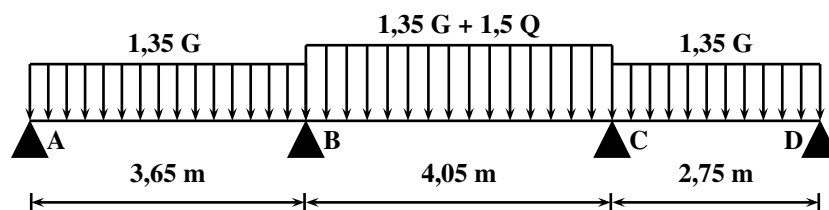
Poutrelle type 2 - cas 2 (ELU)
